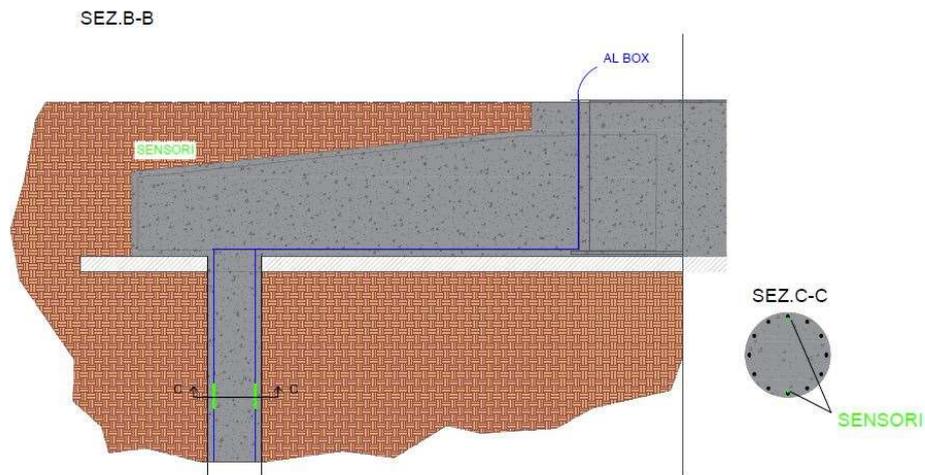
Schema tipo di montaggio dei sensori su un palo di fondazione
